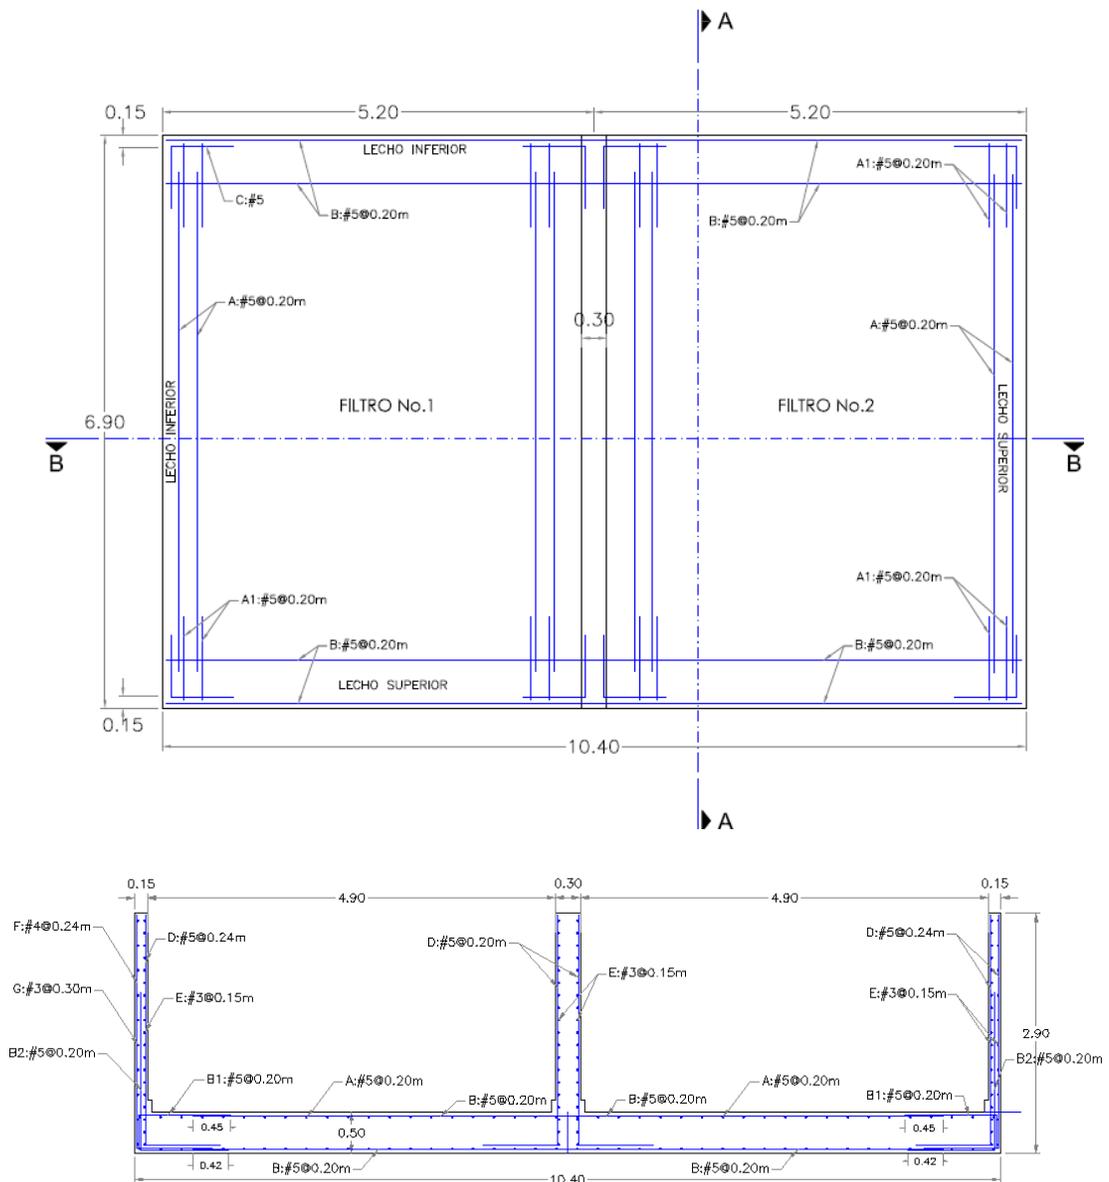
Planta estructural del Filtro Lento de Arena (FLA).
